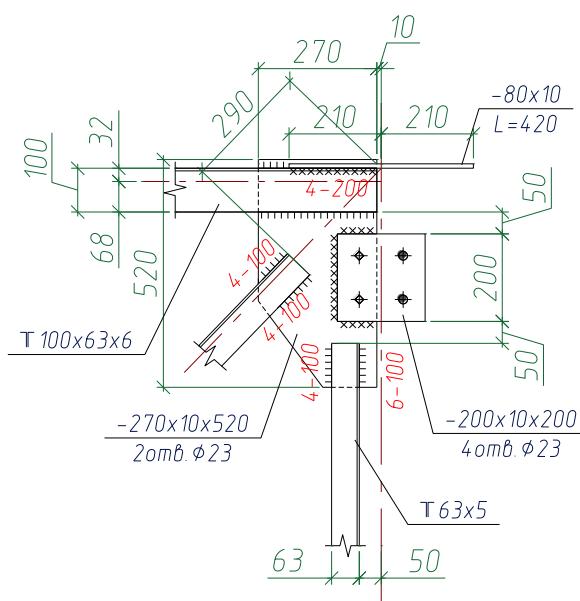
Укрупнённый узел верхнего пояса
